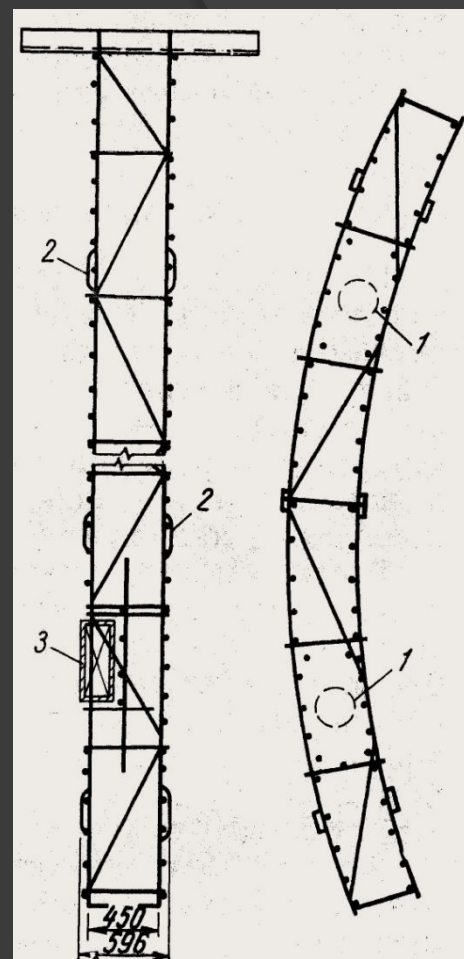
Схема армокаркаса для несущих стен в грунте
